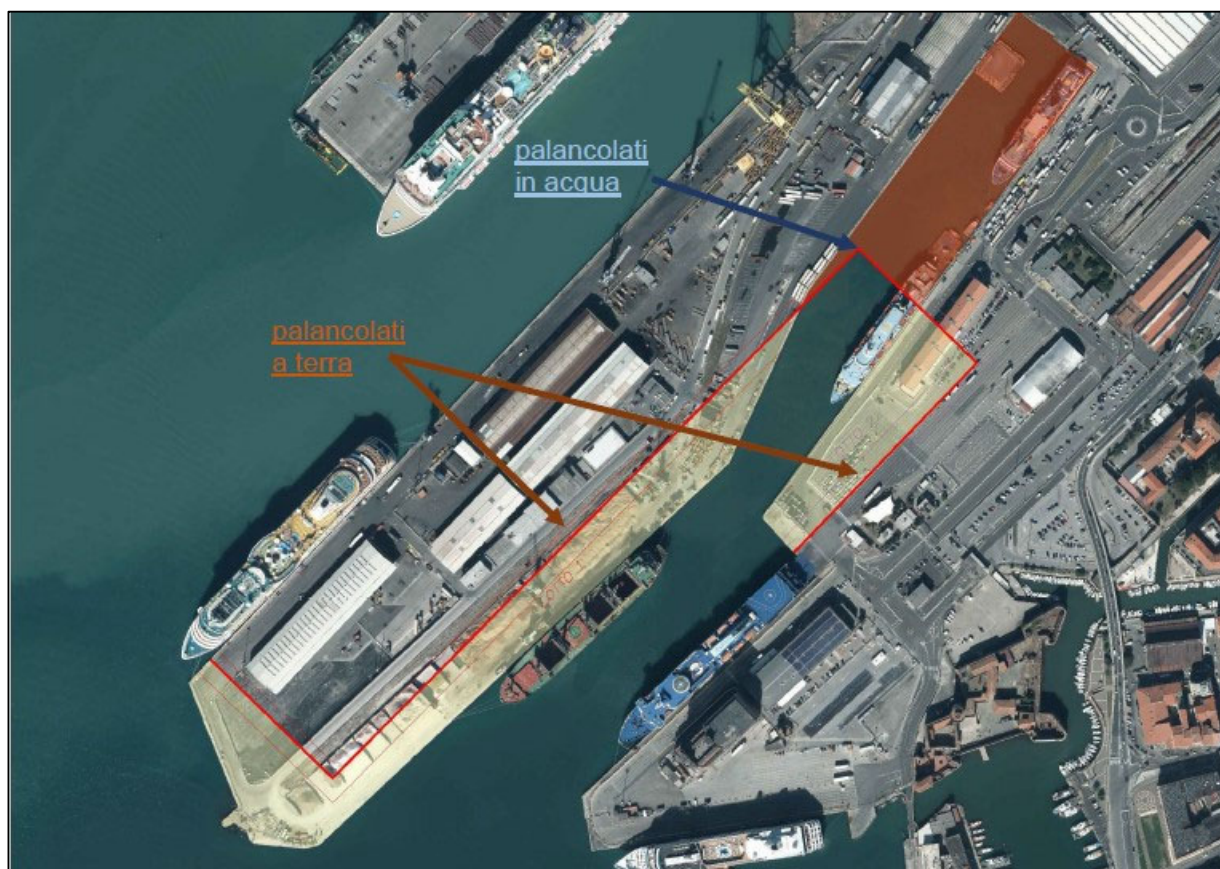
Localizzazione planimetriche delle due diverse tipologie strutturali di opere.
